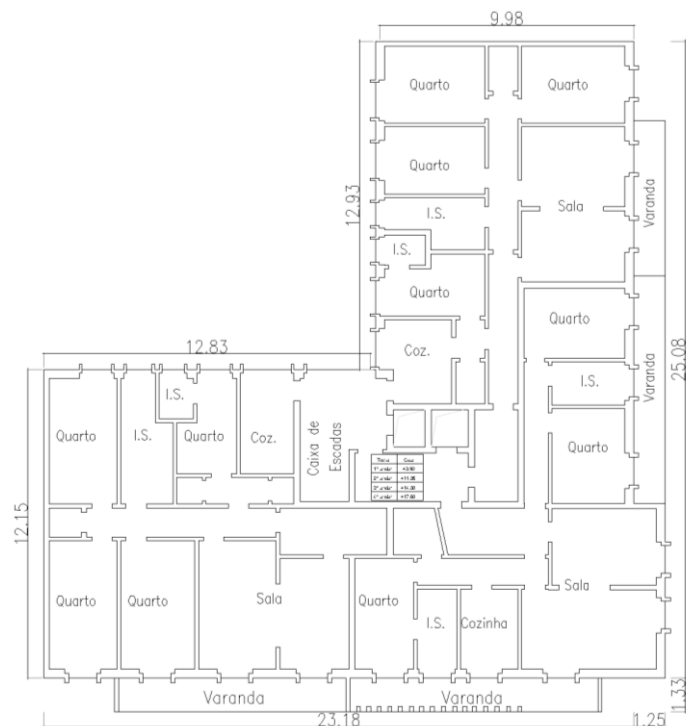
Planta de arquitectura da Cave (Piso Térreo)
